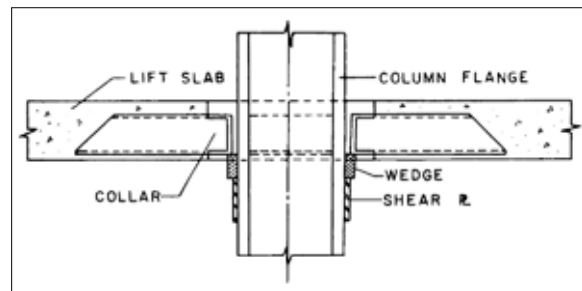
Detalle de la conexión entre el anillo y el pilar<sup>49</sup>
